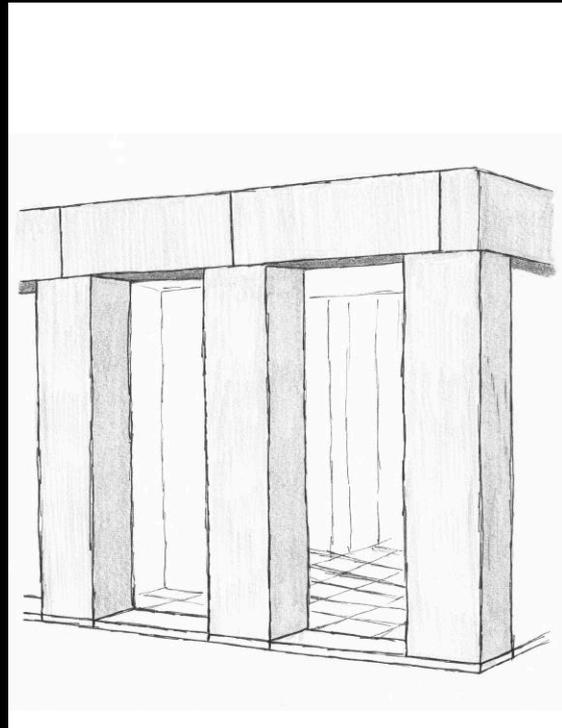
Croquis d'une colonne type en pierre du Pavillon de Middelheim.
